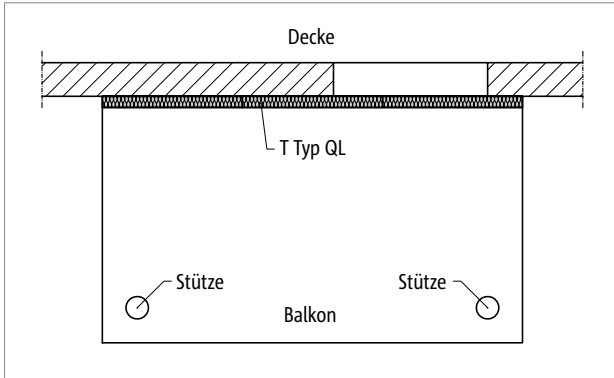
Schöck Isokorb® T Typ QL: Balkon mit Stützenlagerung
